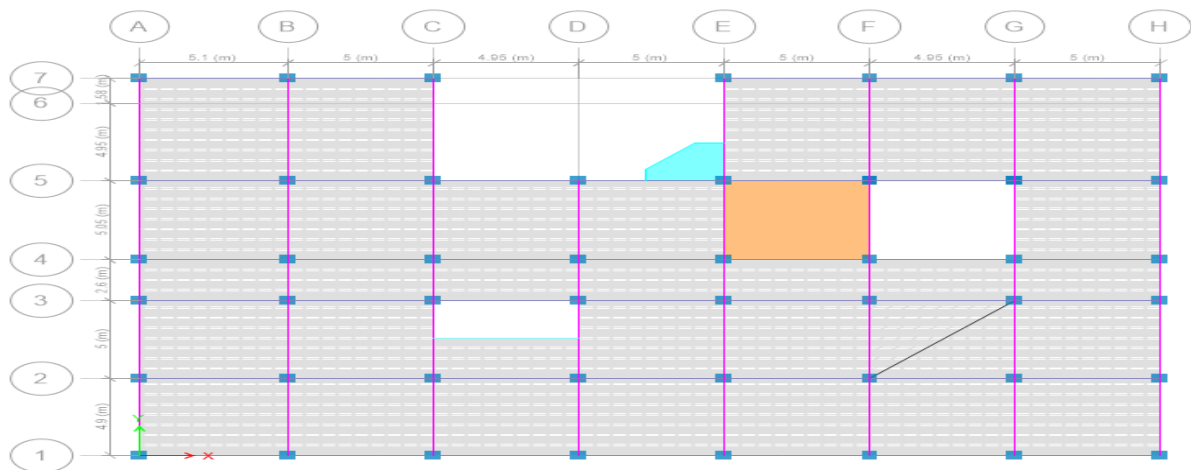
Schéma de la disposition des poutrelles (R+8).
